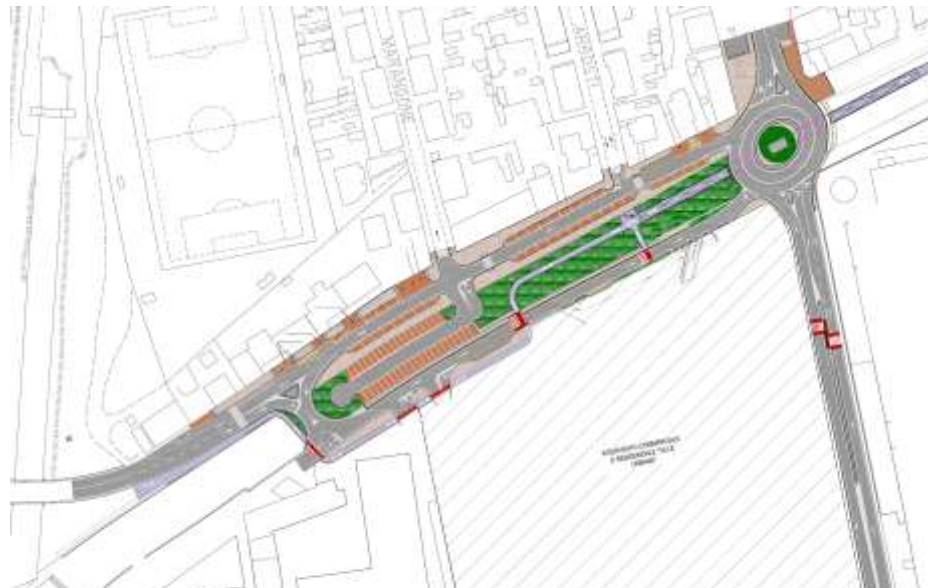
Intervento 3 – Planimetria generale dell'intervento
